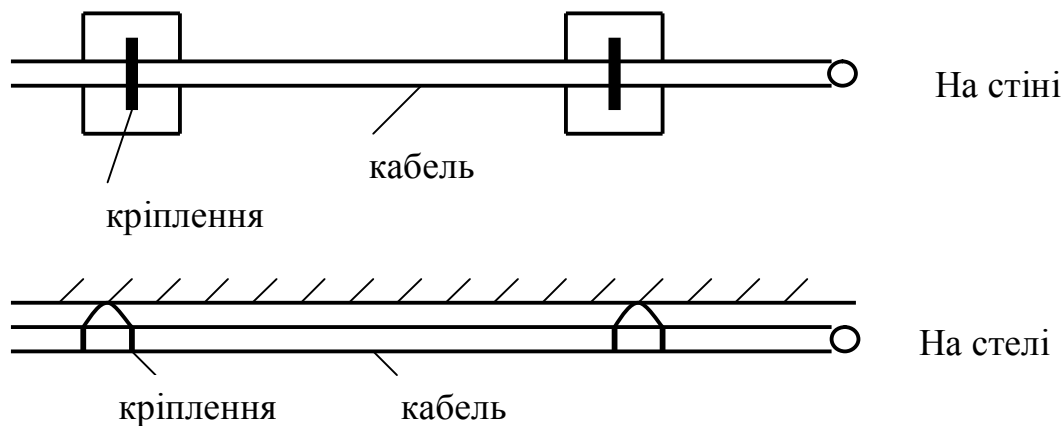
Прокладання мереж відкрито на елементах будівель
